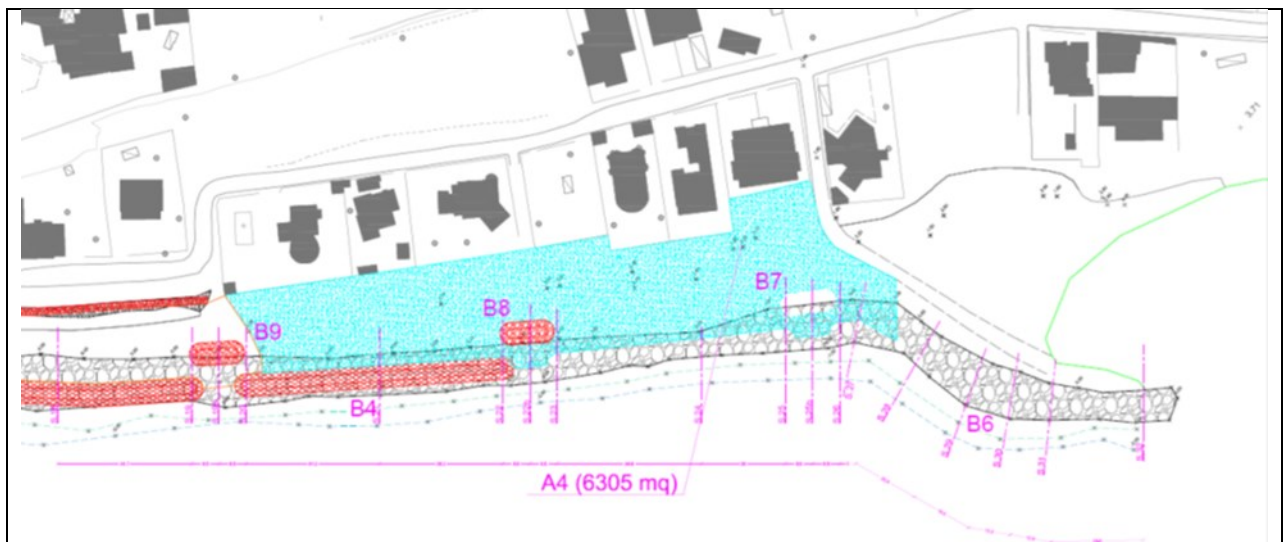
Schema planimetrico intervento Saline area Pantanelle
